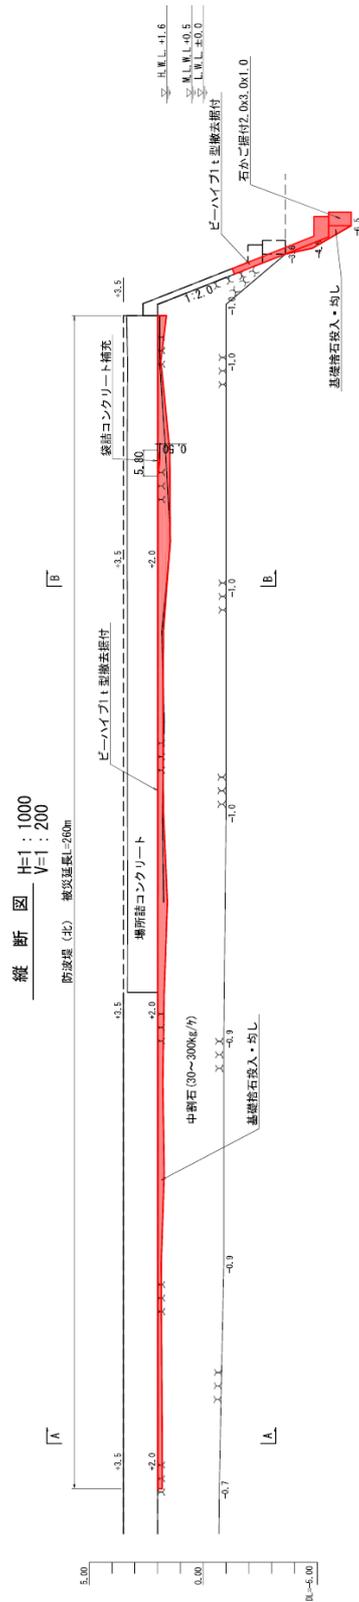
No.5 北防波堤の縦断面図(復旧後)
